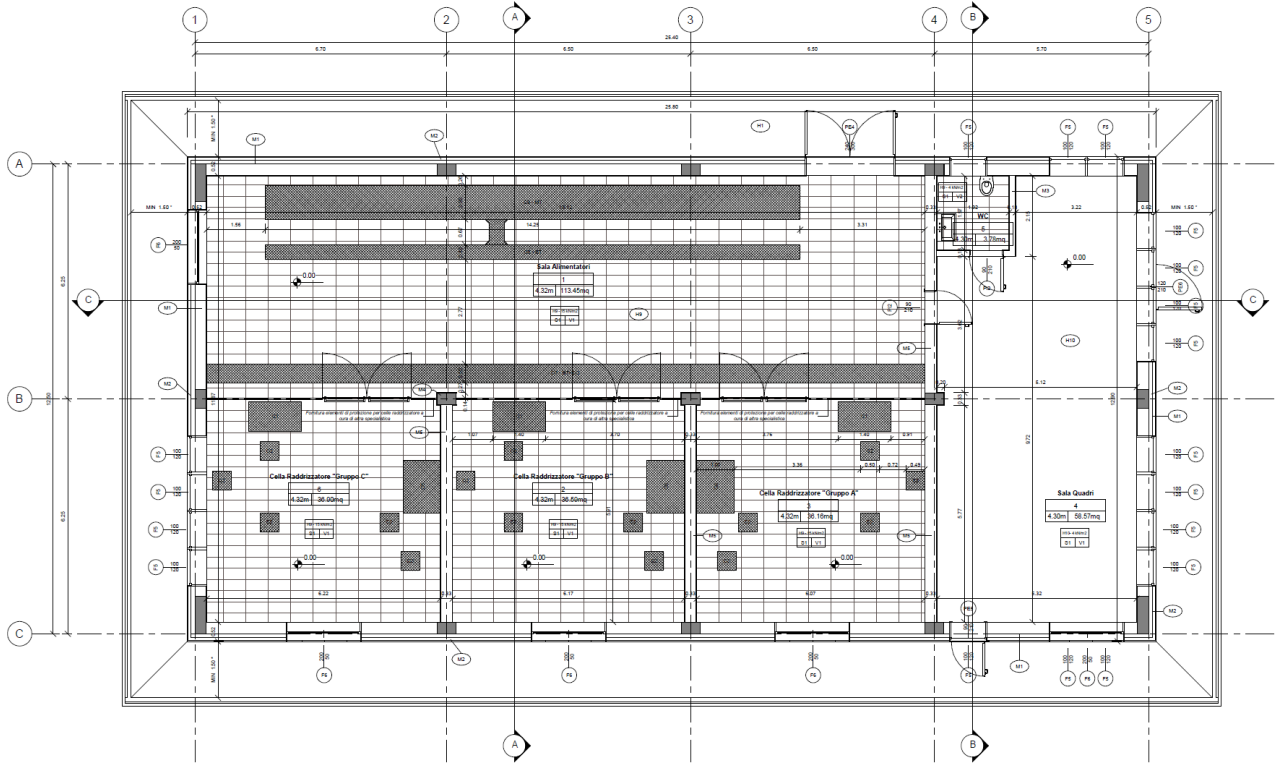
SSE Pavia – Pianta Architettonica Piano Terra
